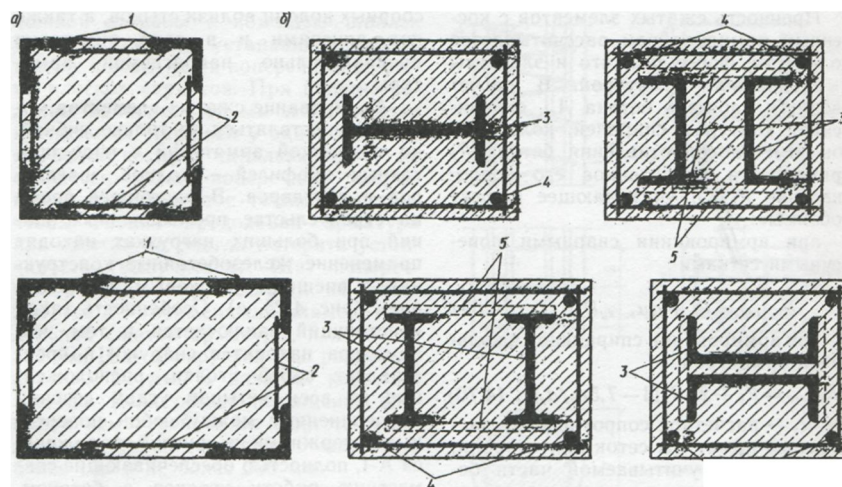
Примеры сечений конструкций с жесткой арматурой
